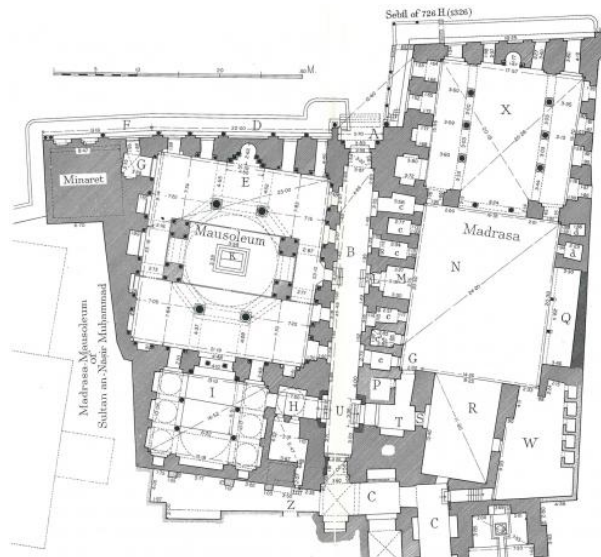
Grundriss Mausoleum und Madrasa, Sultan Qala'un, 1284-85, Kairo, Ägypten.
